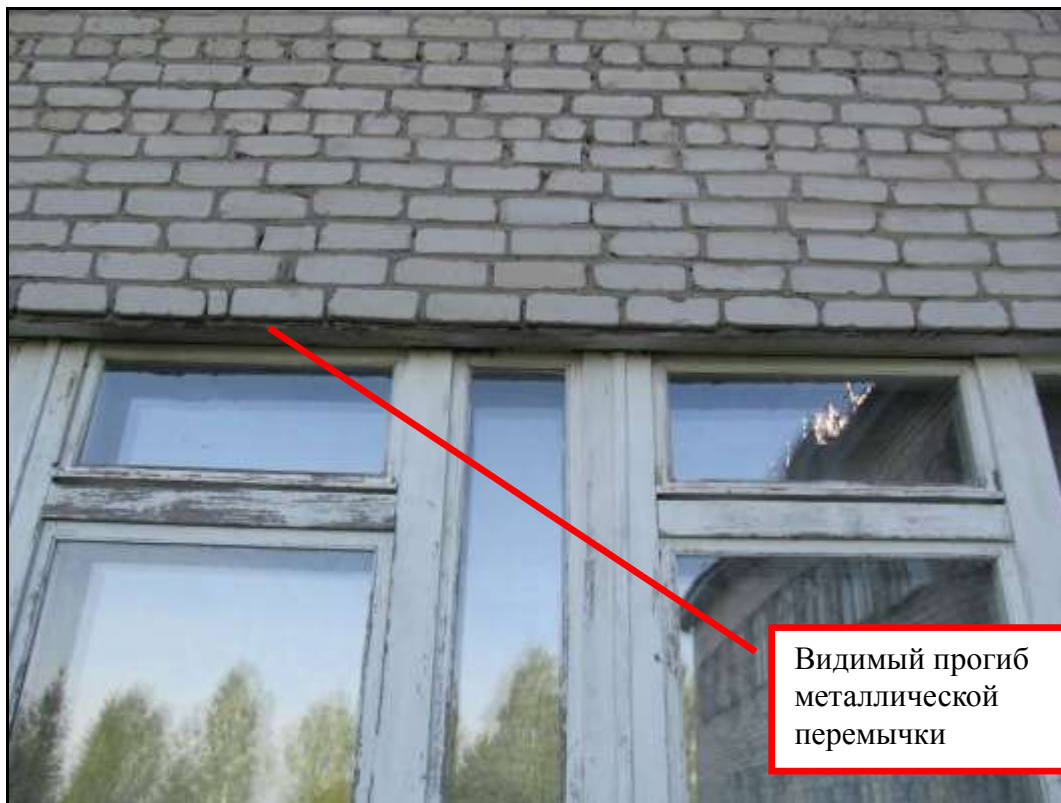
Фрагмент металлической перемычки в стене по оси «4»
